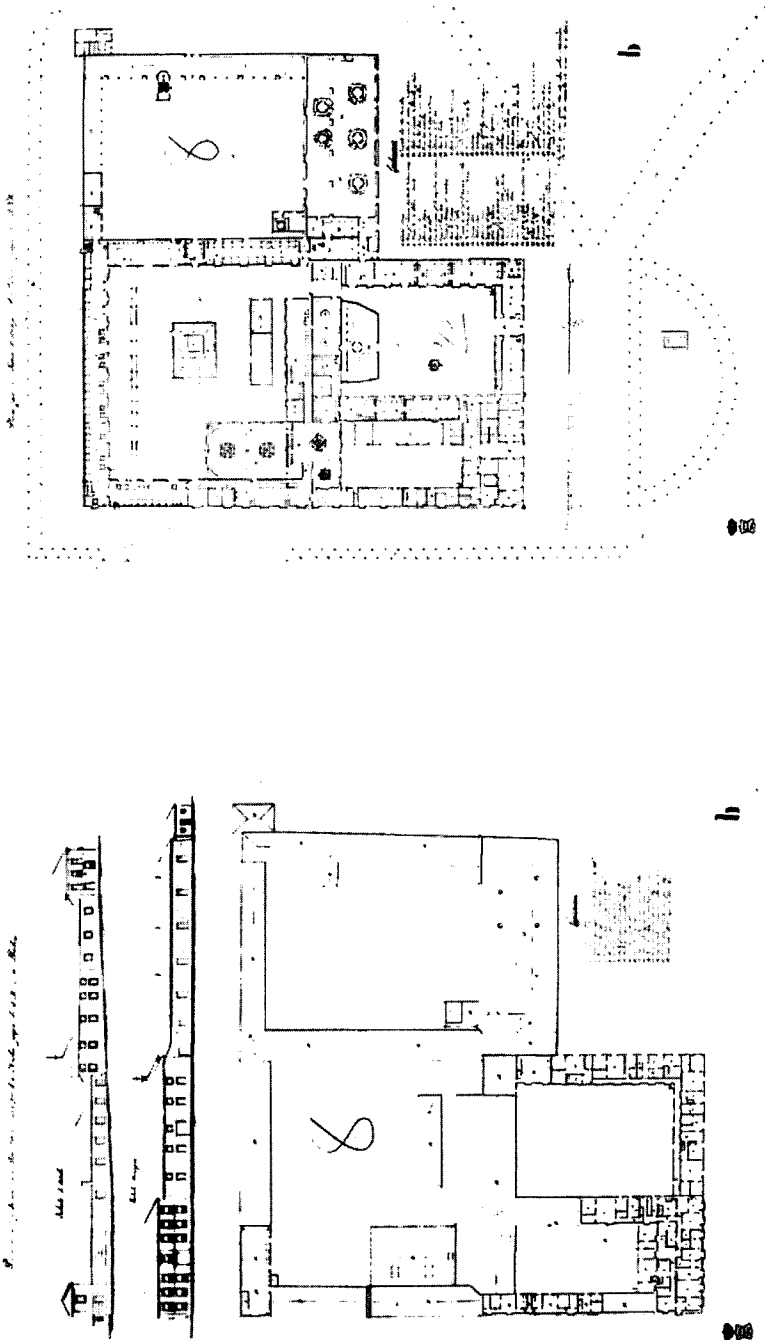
Planos (planta y alzado) de la Fábrica de Porcelana y Loza Fina de La Moncloa (Archivo General de Palacio).
